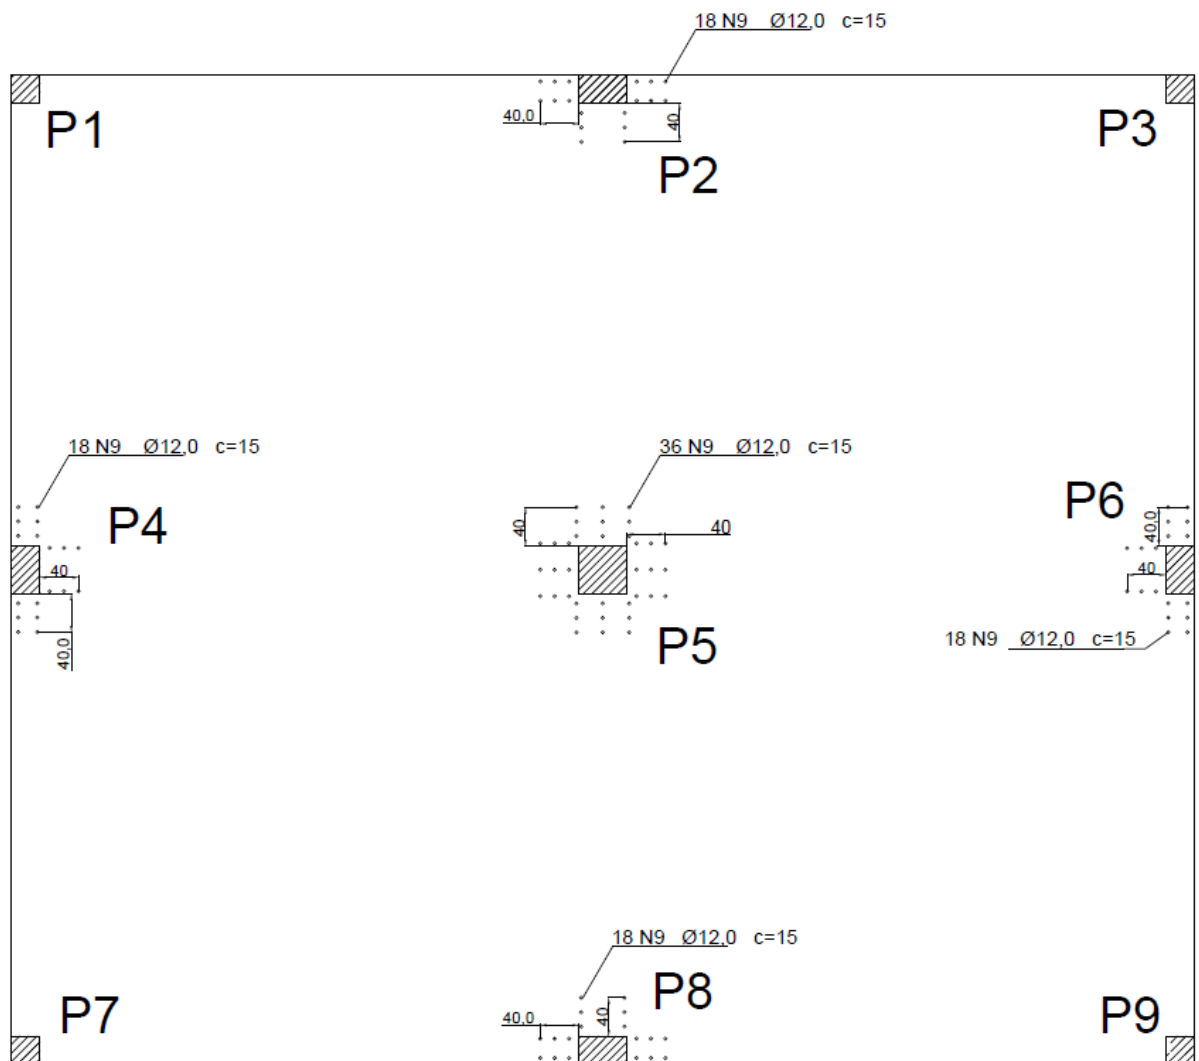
Detalhamento dos pilares na laje pela NP EN 1992-1-1:2010
